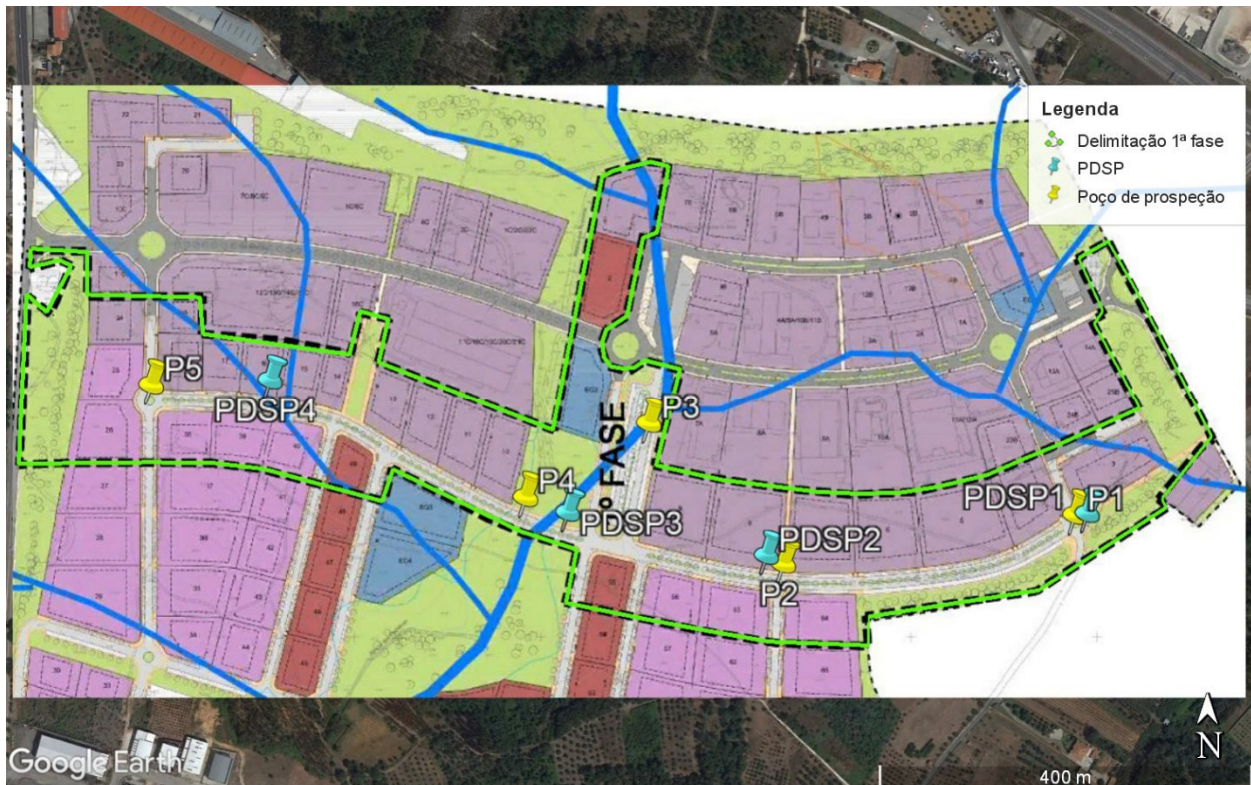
Localização dos poços e dos PDSP na planta do projeto.
